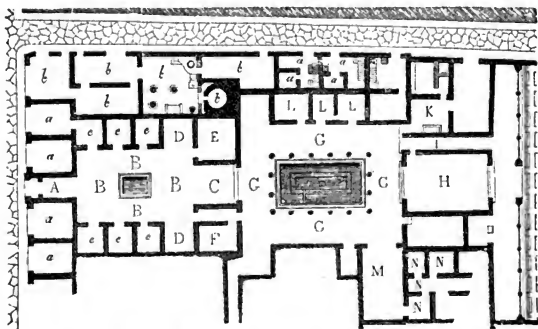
Grundriss eines Wohnhauses in Pompeji.
